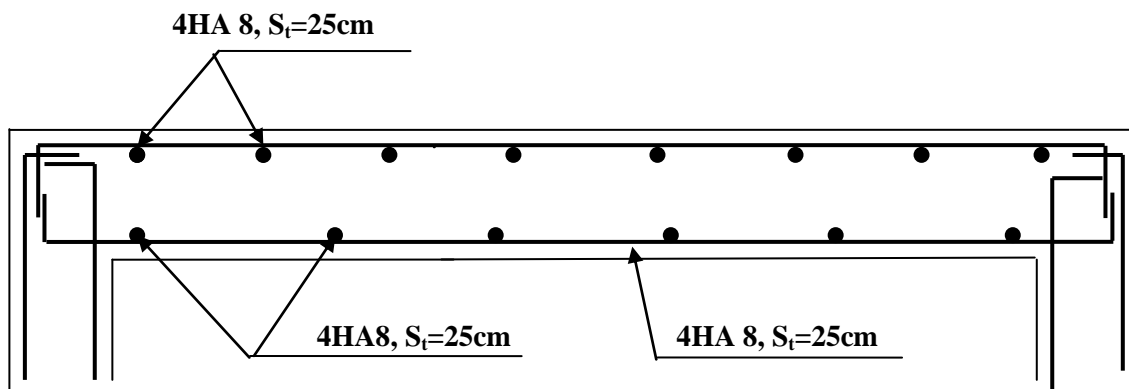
Plan de ferrailage de la salle machine suivant x-x.
